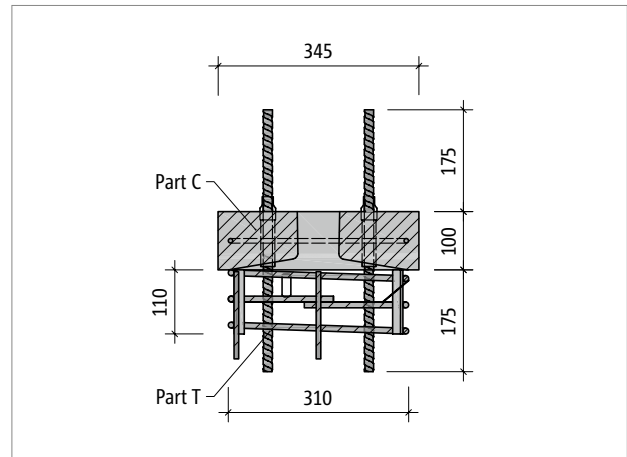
Schöck Sconnex® type P-B350: Aanzicht van bovenaf
